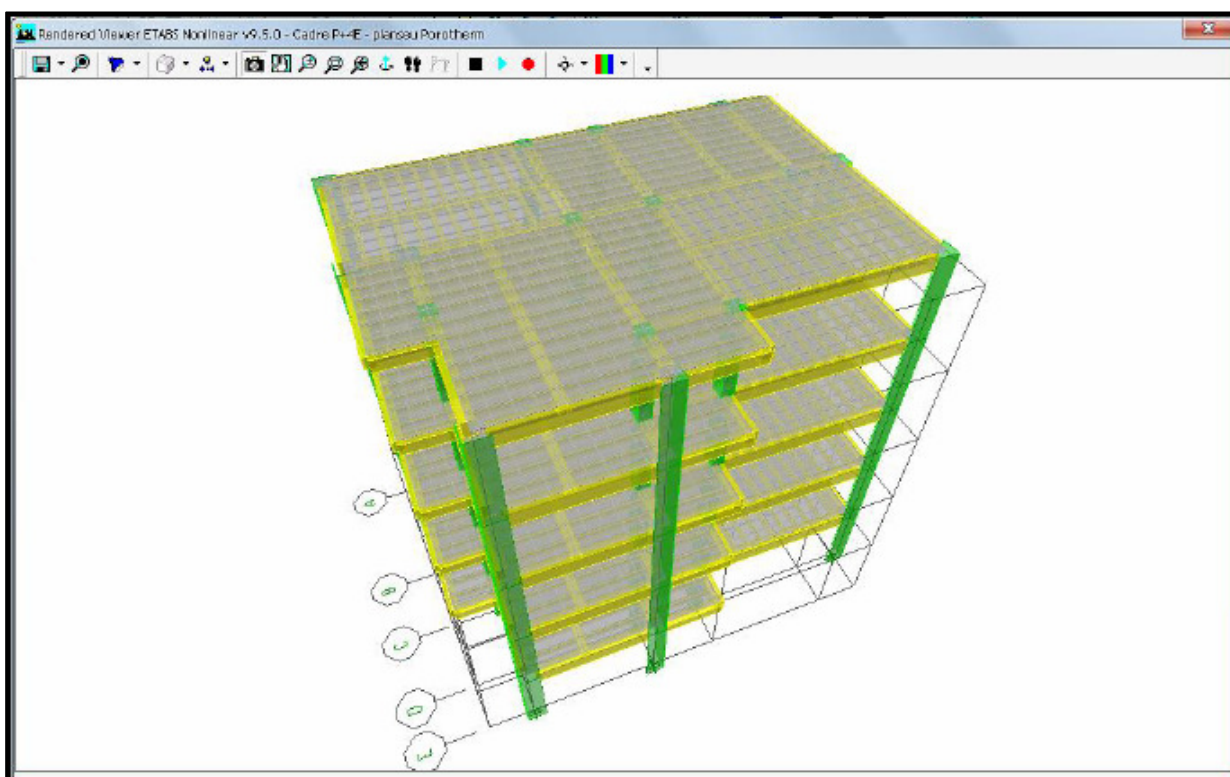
Vizualizare randare model 3D – structura in cadre de beton armat
